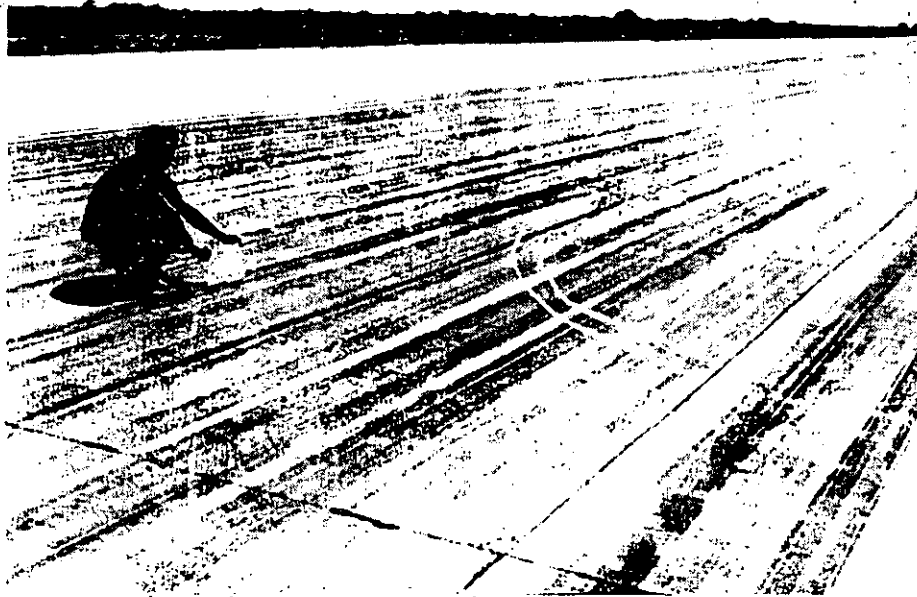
Grietas en esquina en la zona de toma de contacto de la pista. Probable fallo estructural debido a la repetición de los esfuerzos de impacto provocado por la rugosidad de la superficie del pavimento. En esta zona de la pista los aviones llevan su mayor energía cinética durante el carrera de despegue
